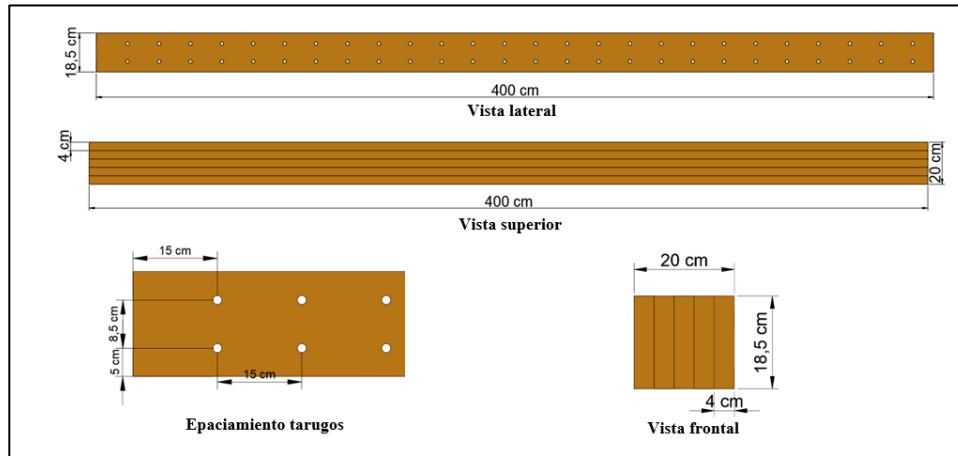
Vistas con detalles viga de laminación continua a ensayar
